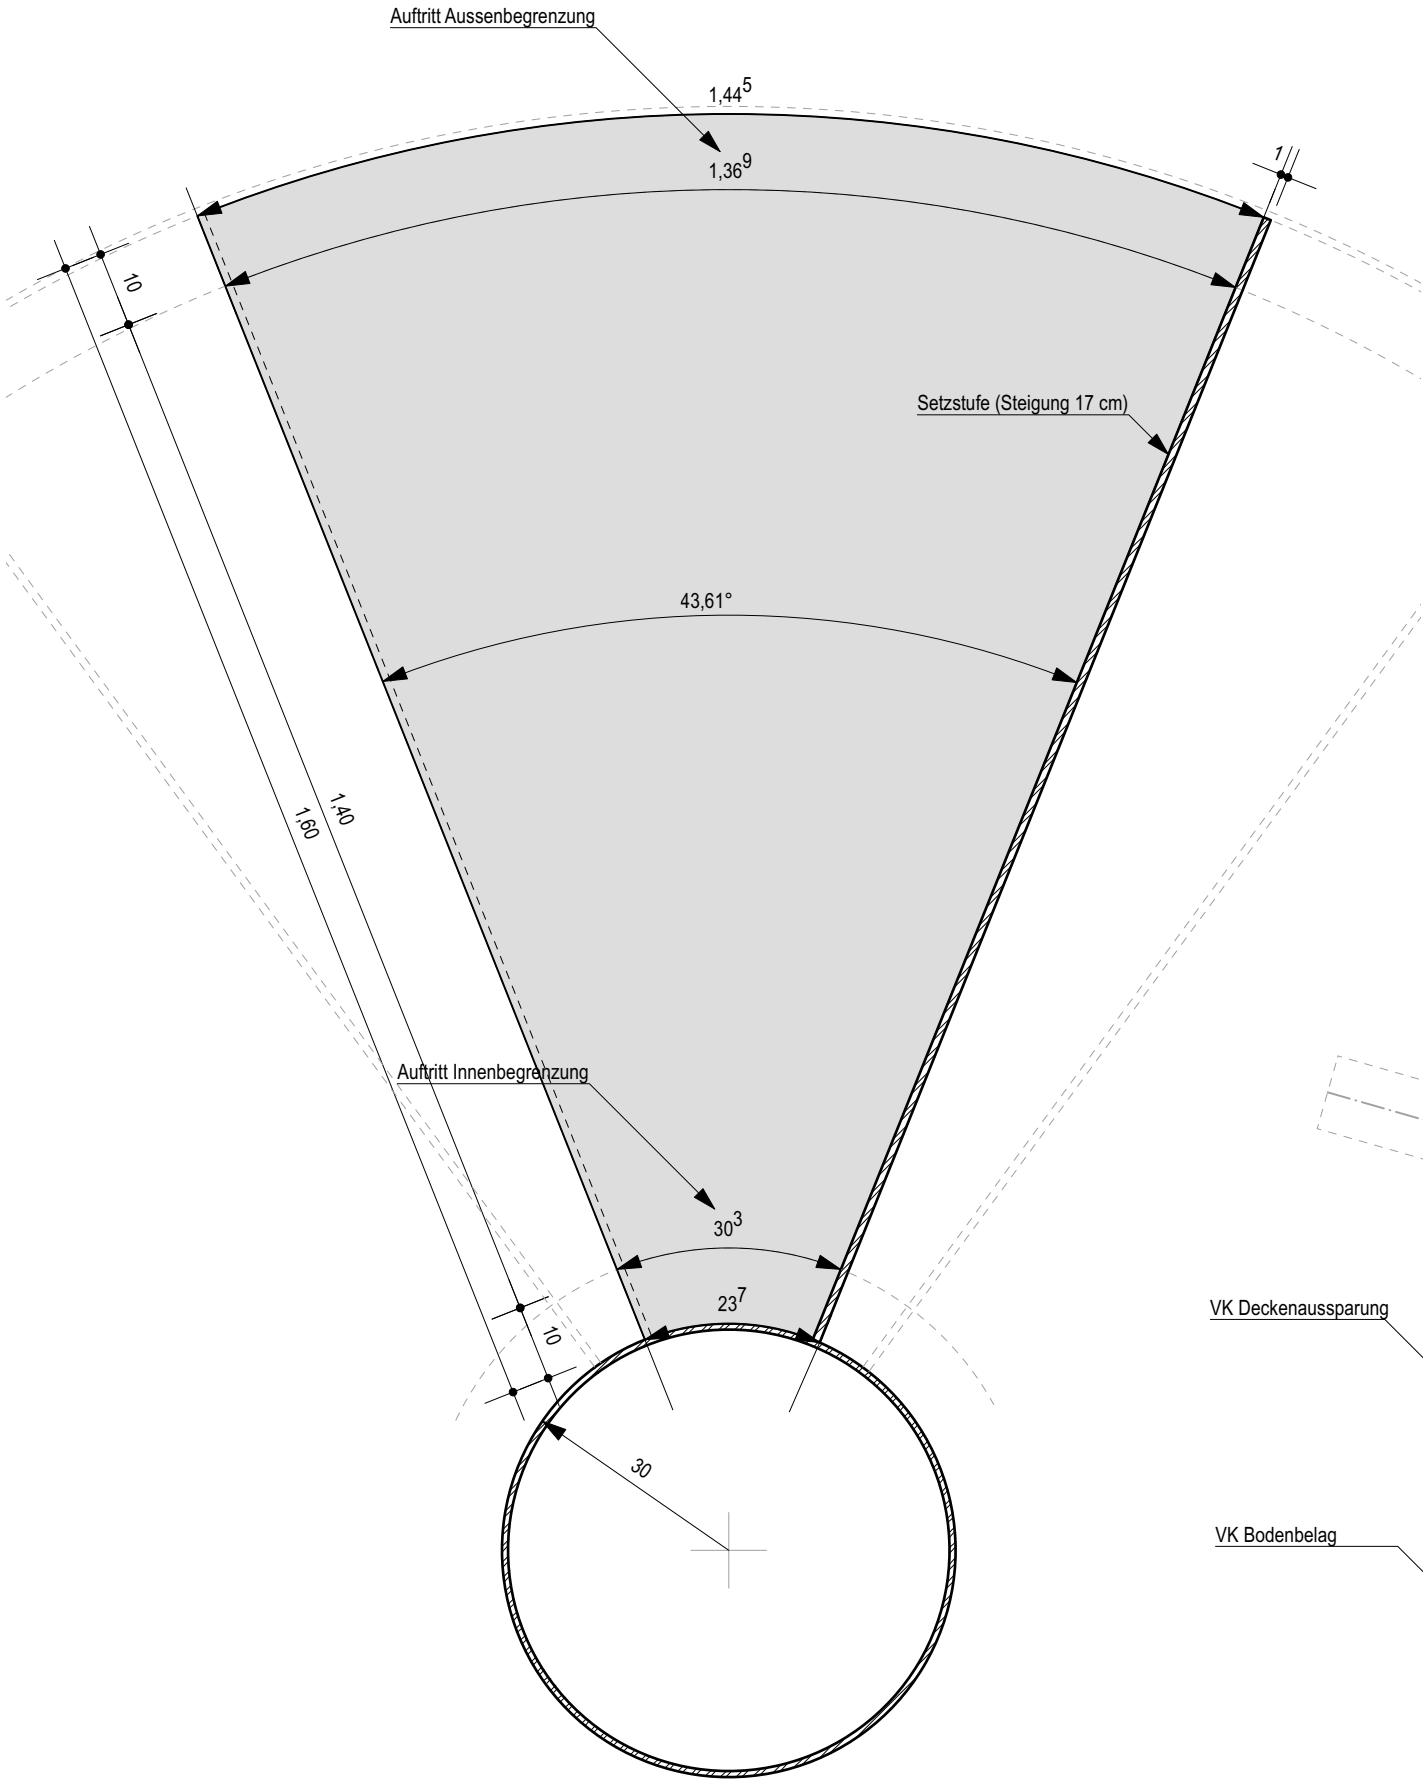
Detailschnitt B-B, Antrittstufe (Abwicklung) 1:5
